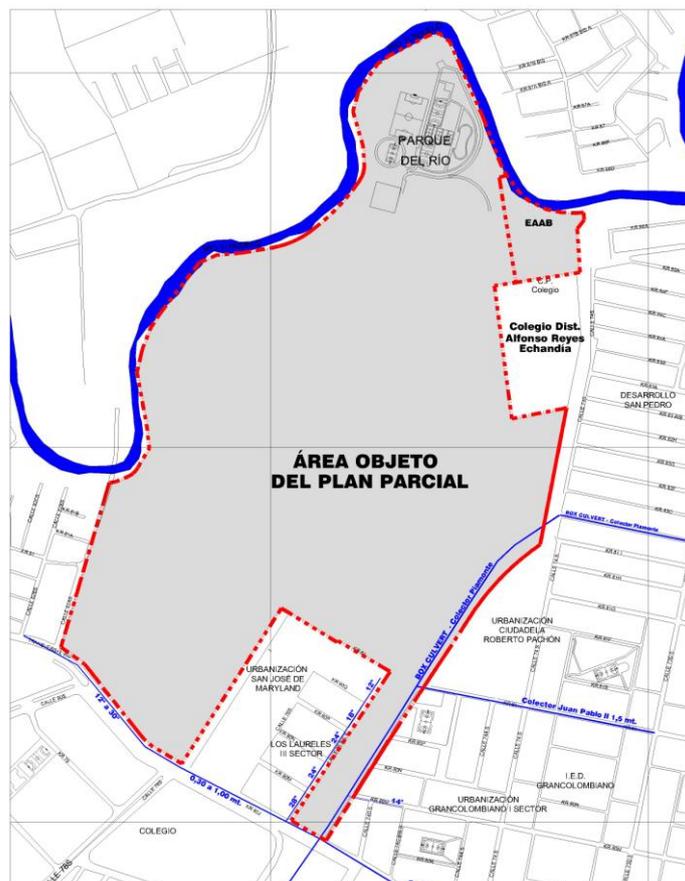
Estructura de servicios públicos - Redes de Alcantarillado Pluvial
